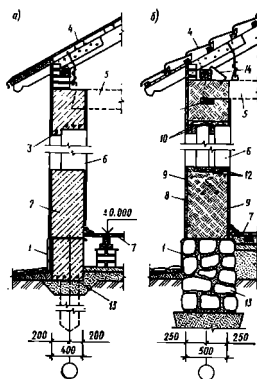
Разрезы наружных стен одноэтажных жилых домов из местных материалов:
